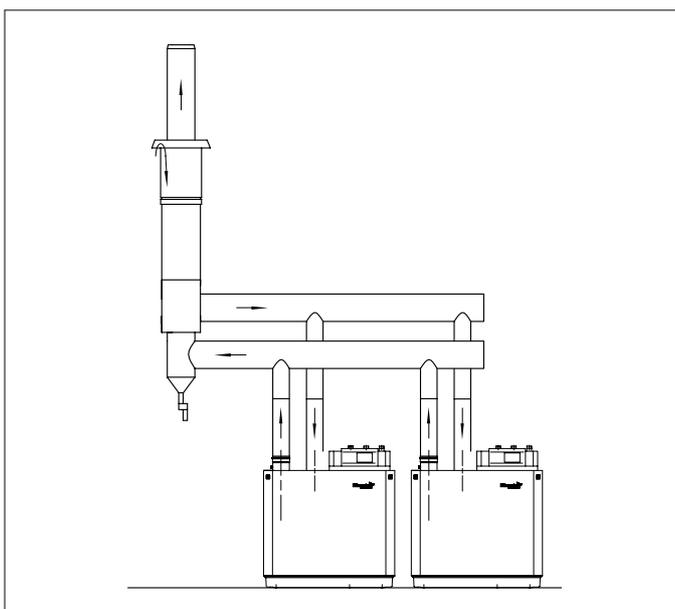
Installation en cascade avec deux chaudières, raccordement sur ventouse
